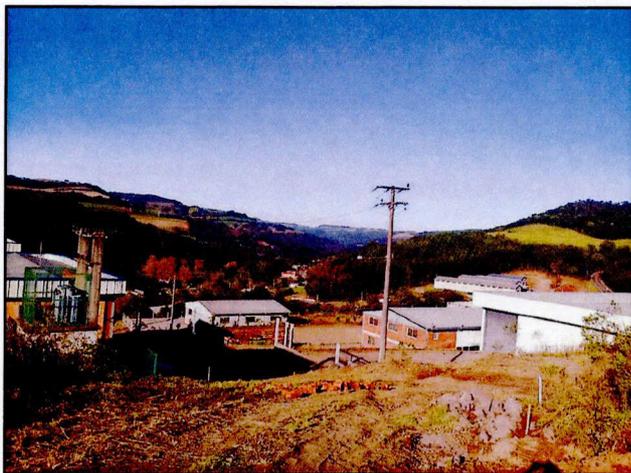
vista sul do leito da Rua a ser regularizada, conforme ponto 02 do projeto;
